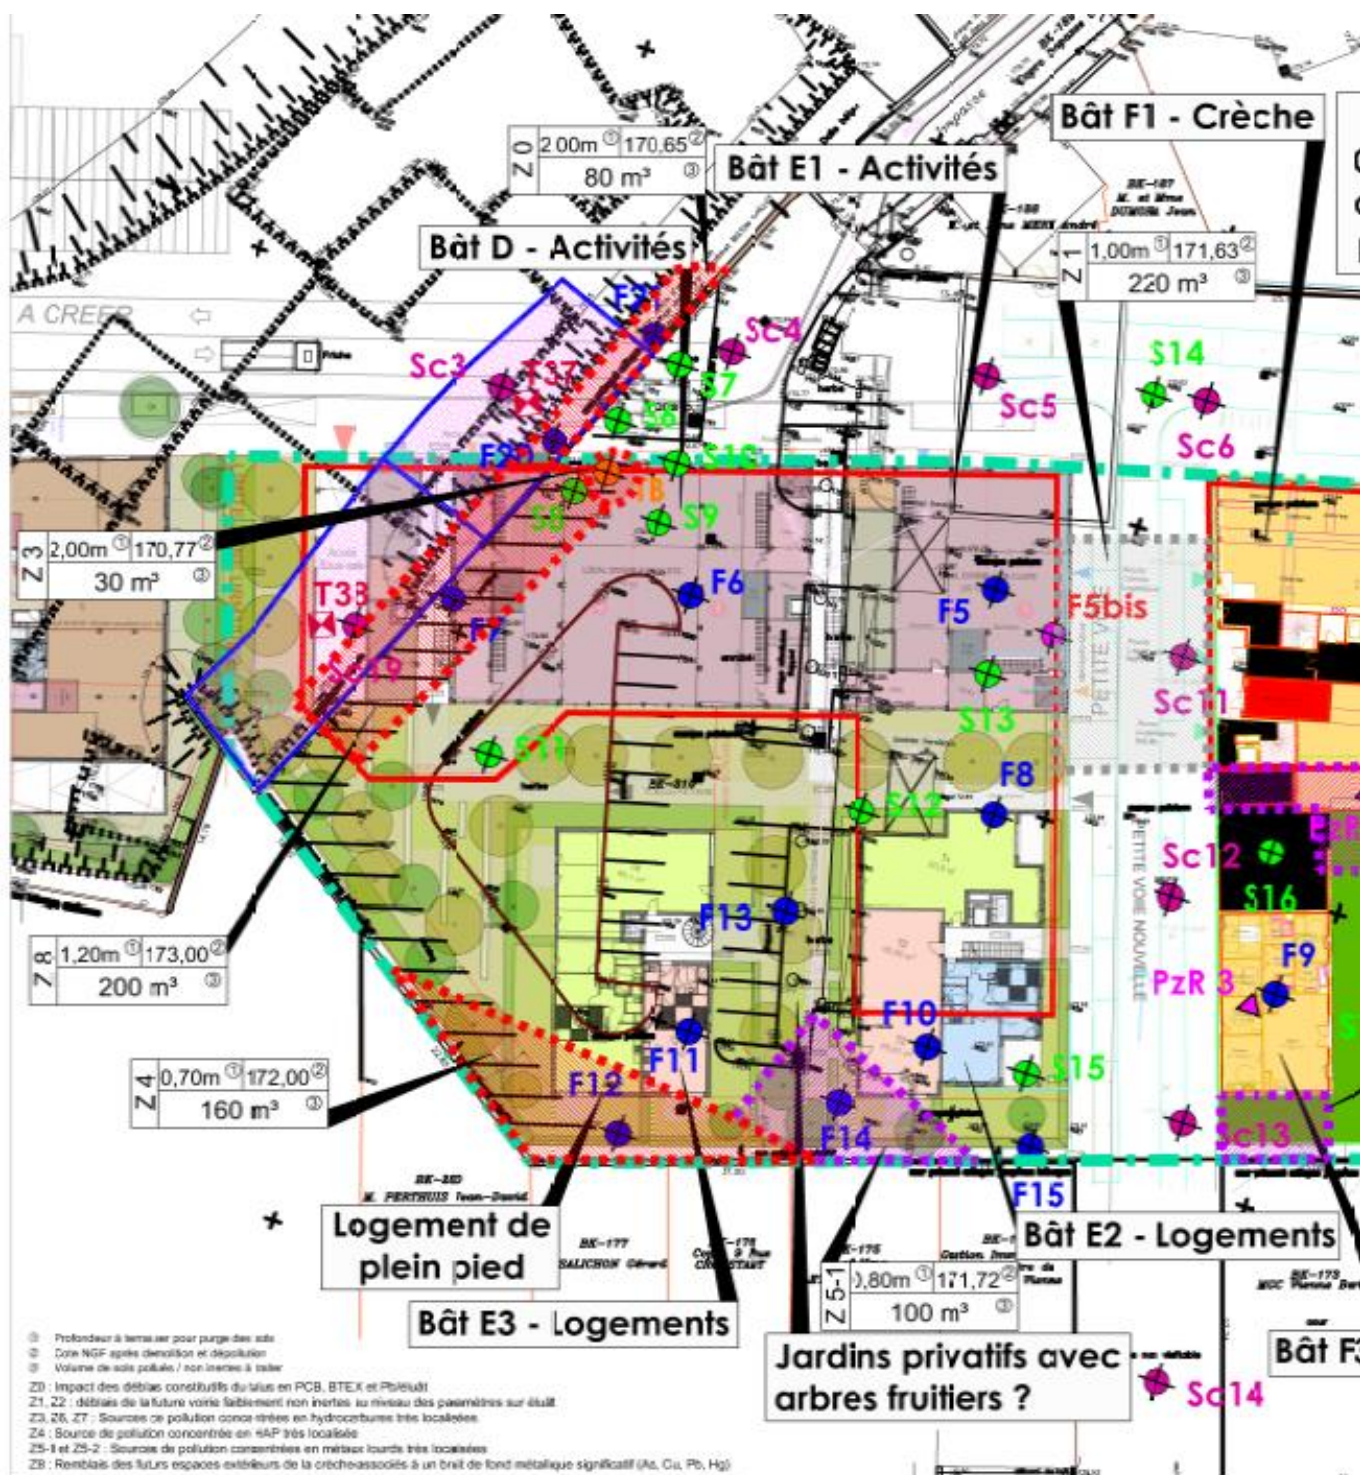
Zonage des zones à purger (extrait du plan de gestion de janvier 2021)
